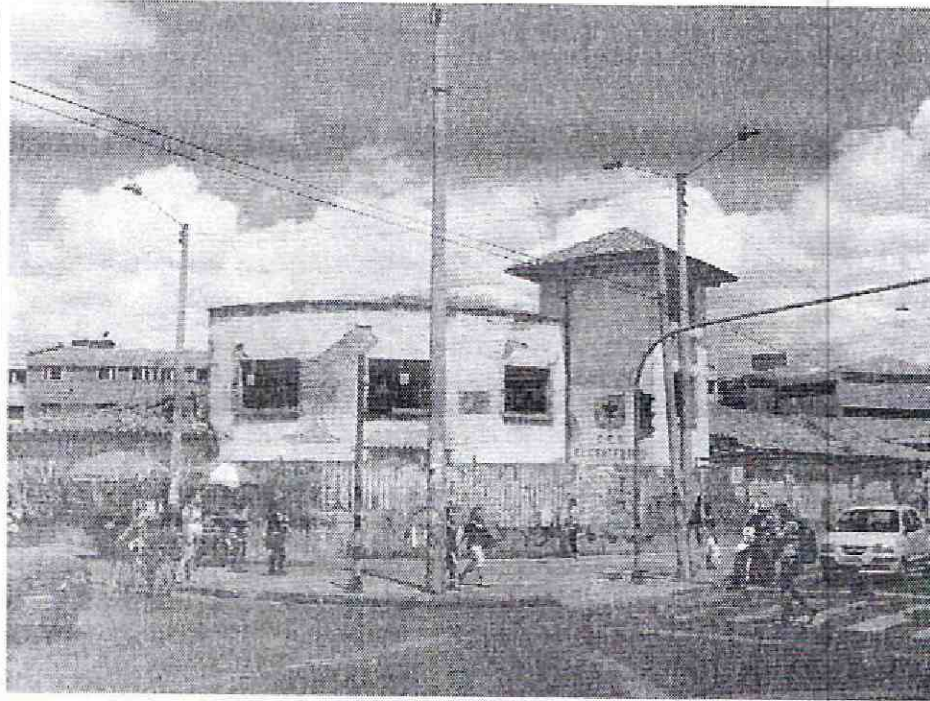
Fachada del inmueble esquina de la Transversal 21 A con Diagonal 21 A Sur. Pérdida de revoque (pañete) en muros
